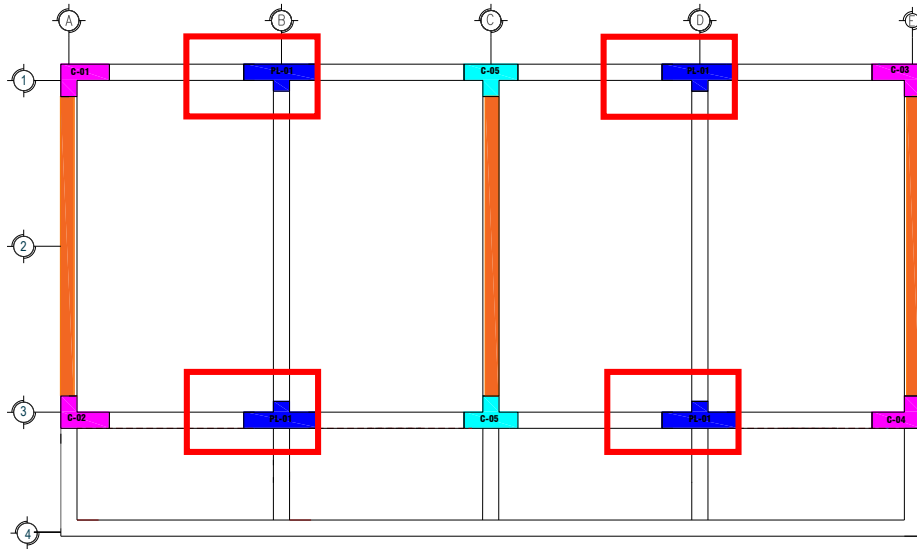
Distribución de placas de concreto armado en la planta del bloque A
